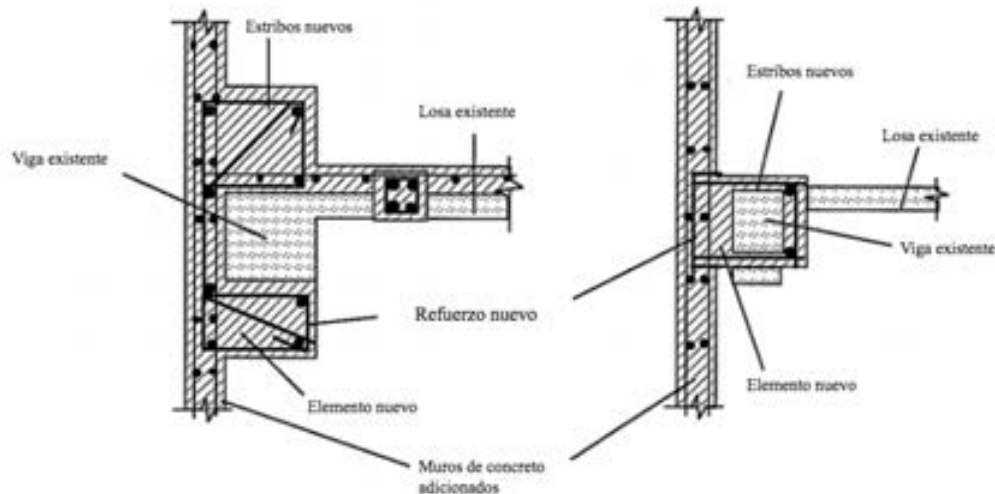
Detallado de muros excéntricos (Aguilar, J., et al., 1996)
